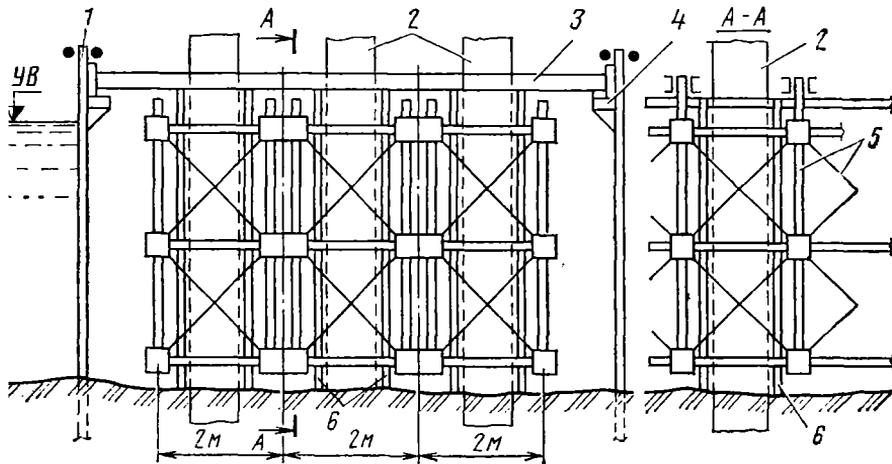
Каркас из элементов УИКМ для направления оболочек диаметром до 3 м:
